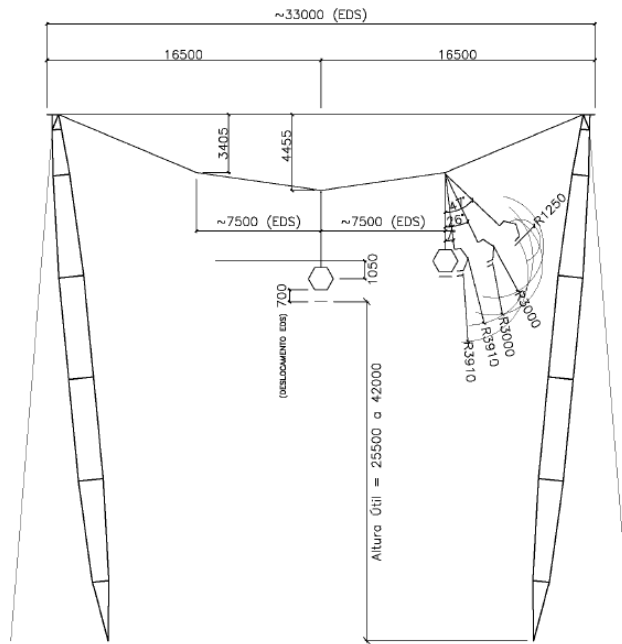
Torre Estaiada Cross Rope de Suspensão Leve
